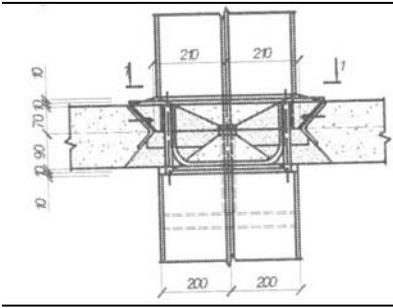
Стык колонны с плитой перекрытия серия «КУБ-4»
